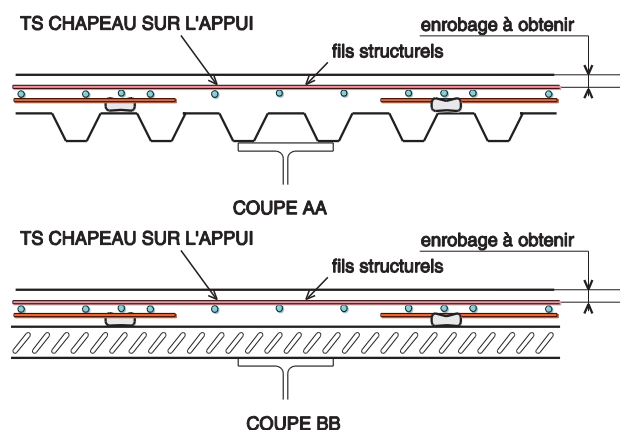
Mise en place du ferrailage dans la dalle – phase 3
